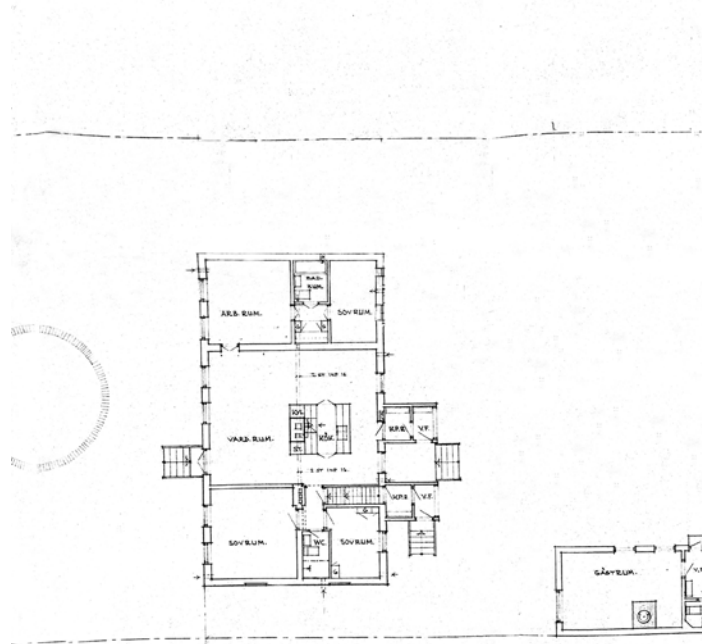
Plano original de la planta de acceso de la casa de Kävlingevägen 32. Inédito. Fotografía del autor.
